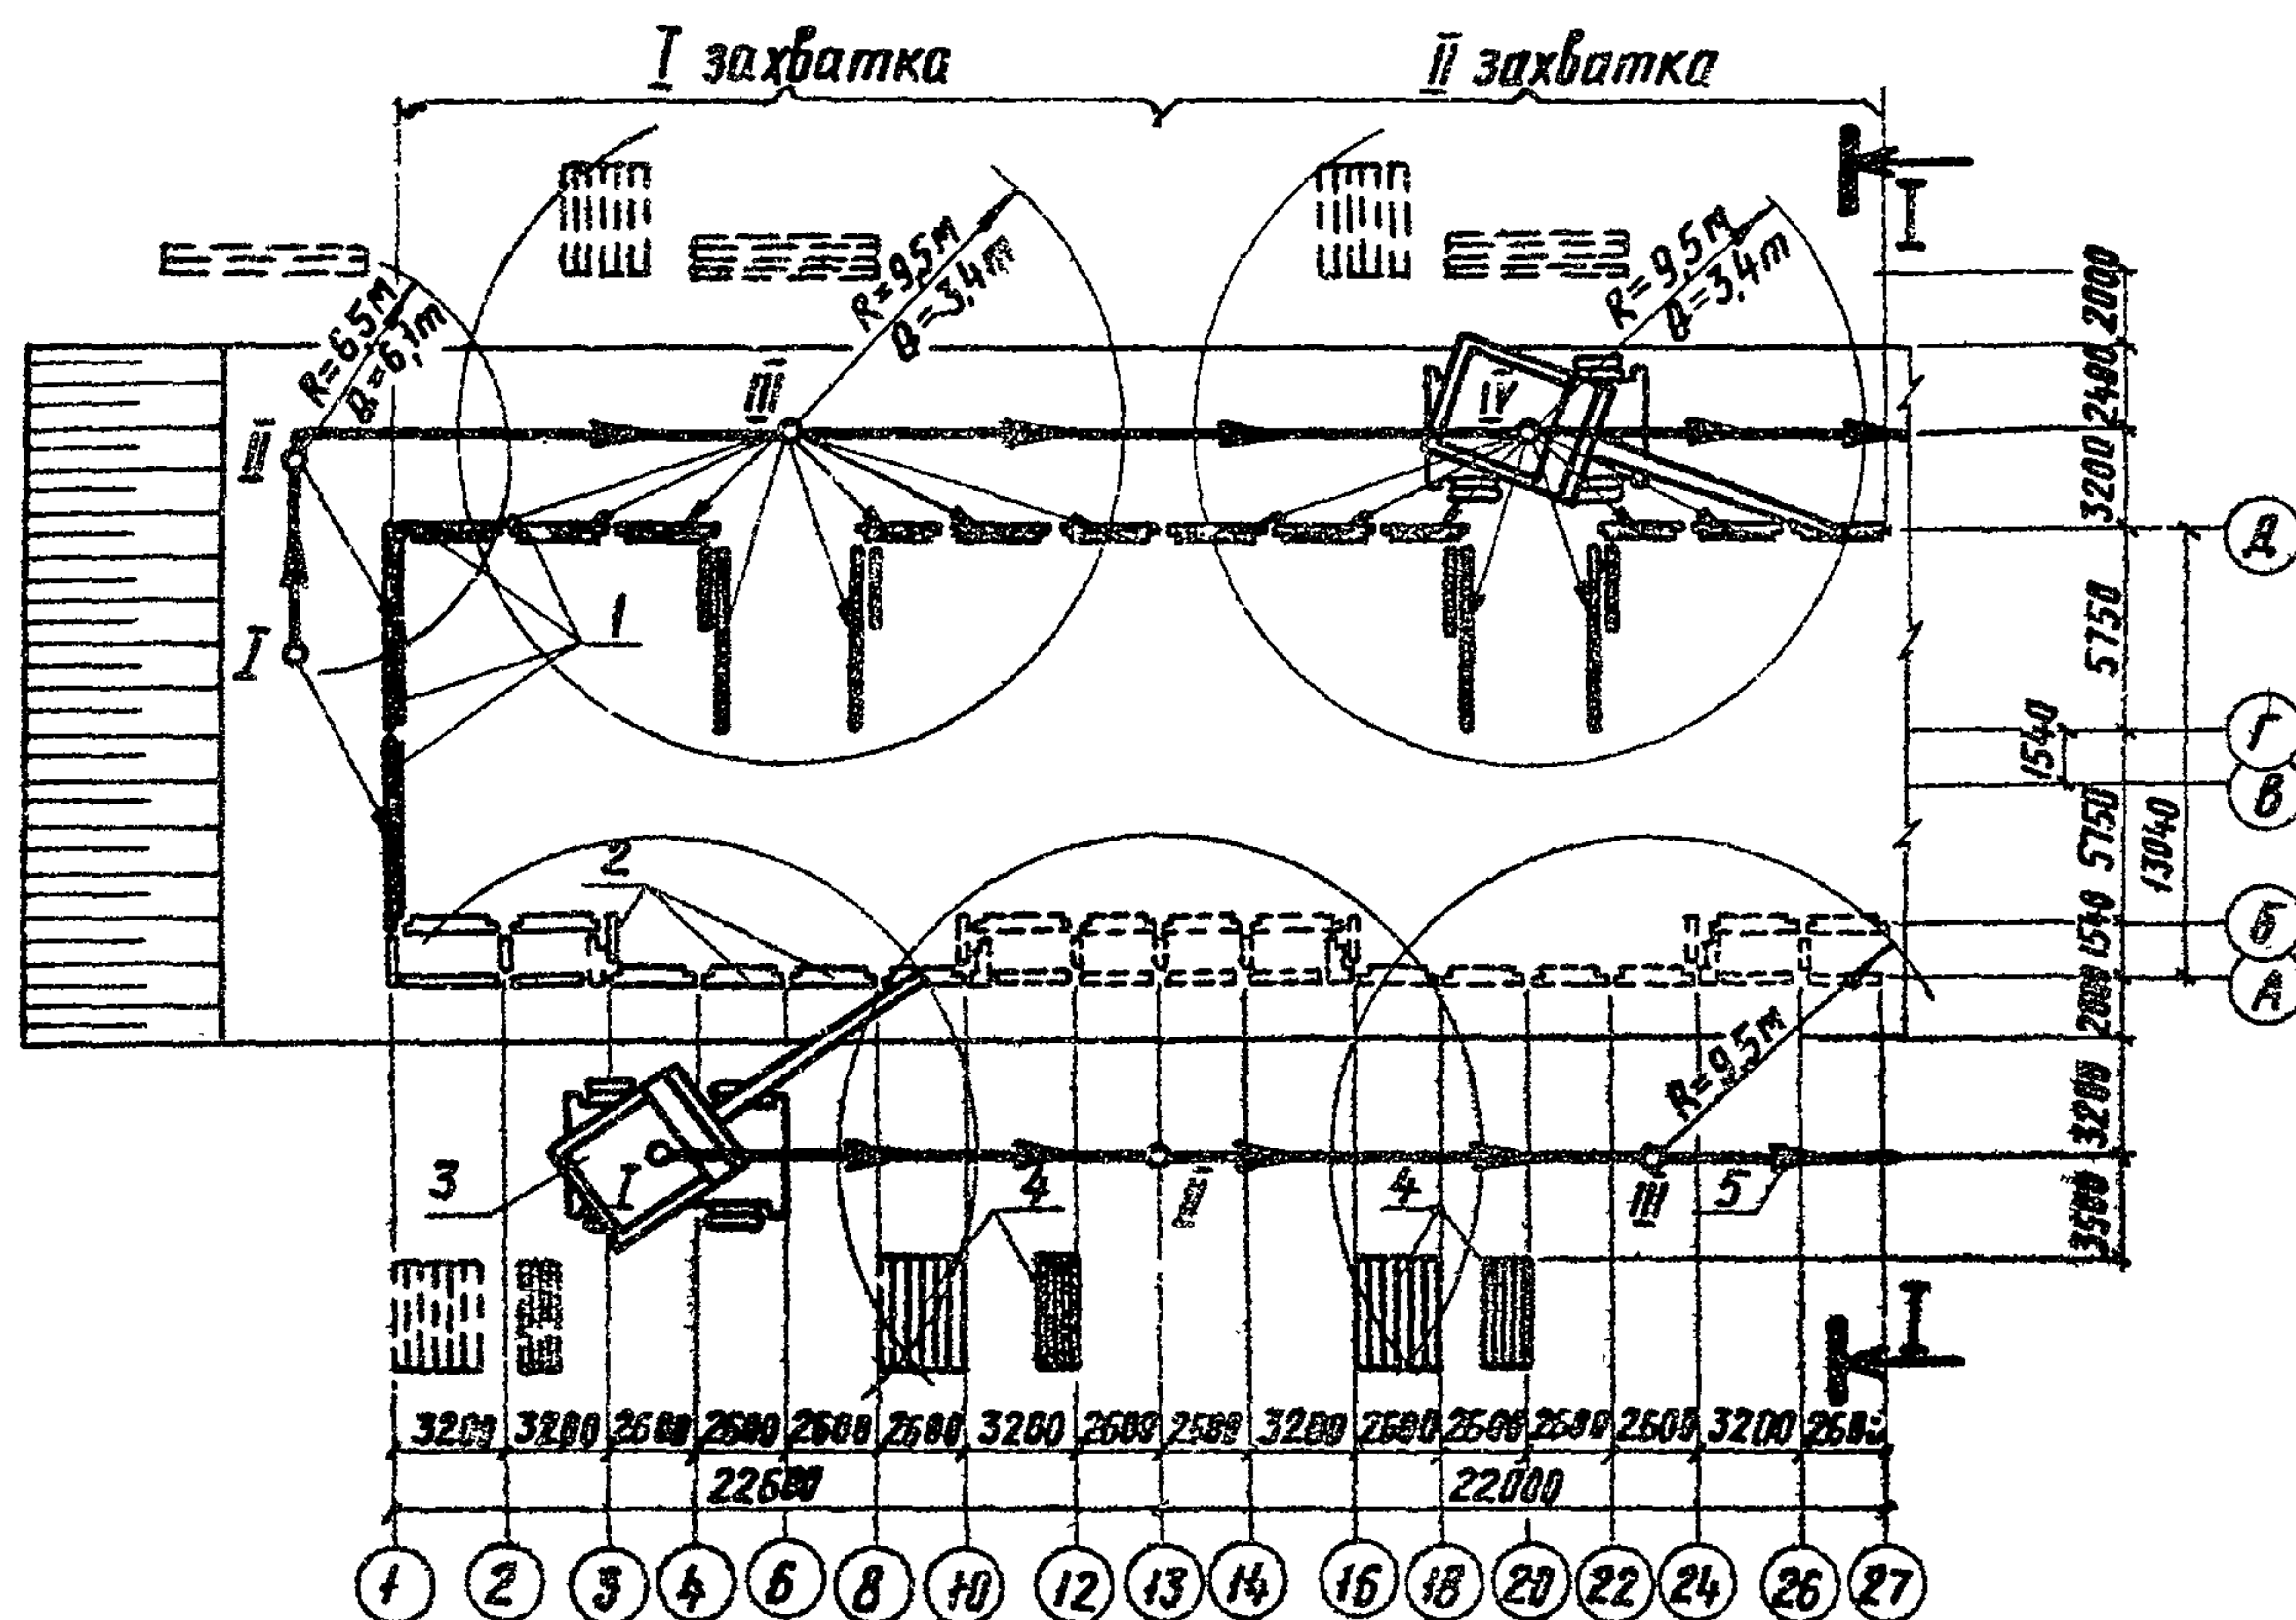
Схема организации работ по монтажу цокольных стеновых панелей:
